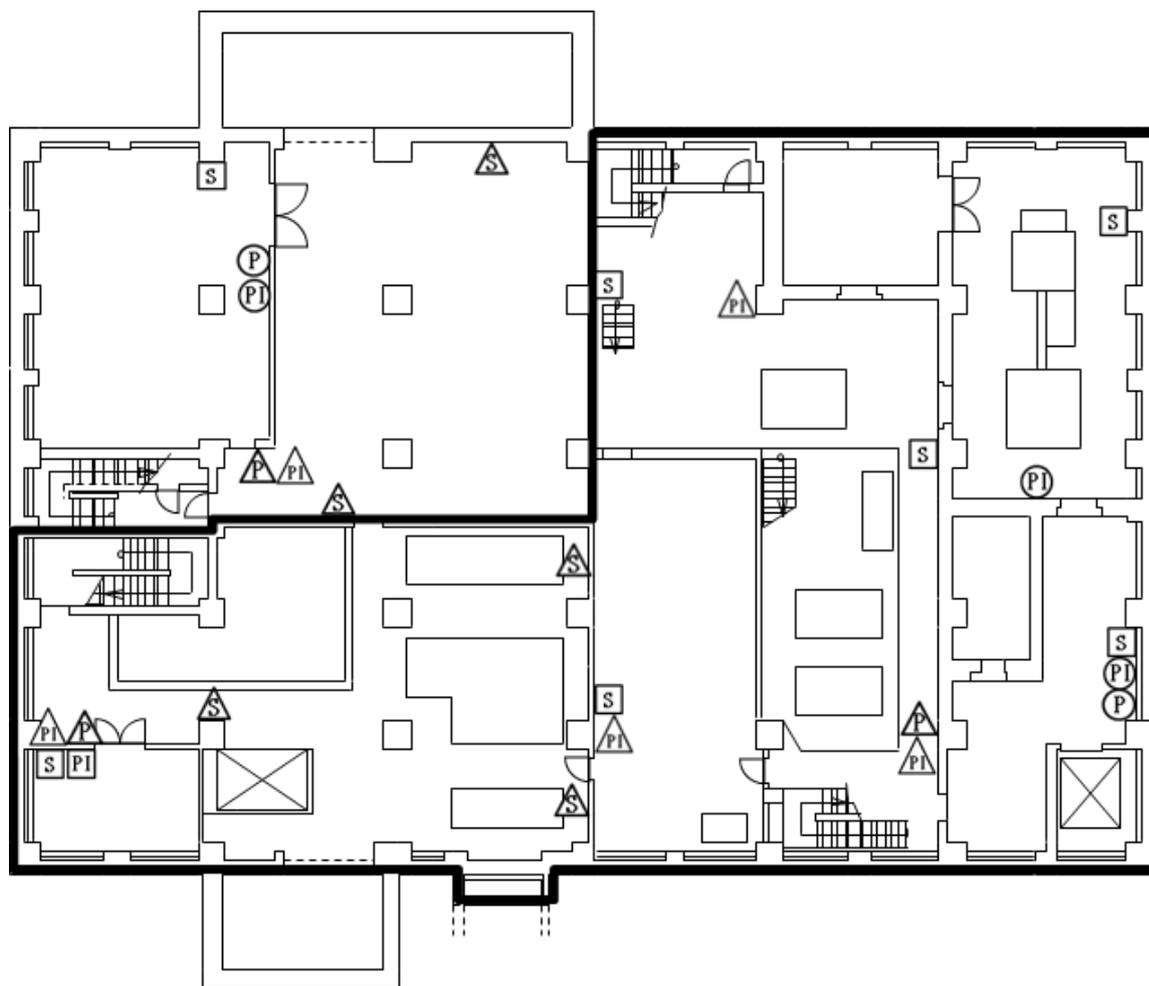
β・γ 固体処理棟Ⅲ2階 消防設備配置図
